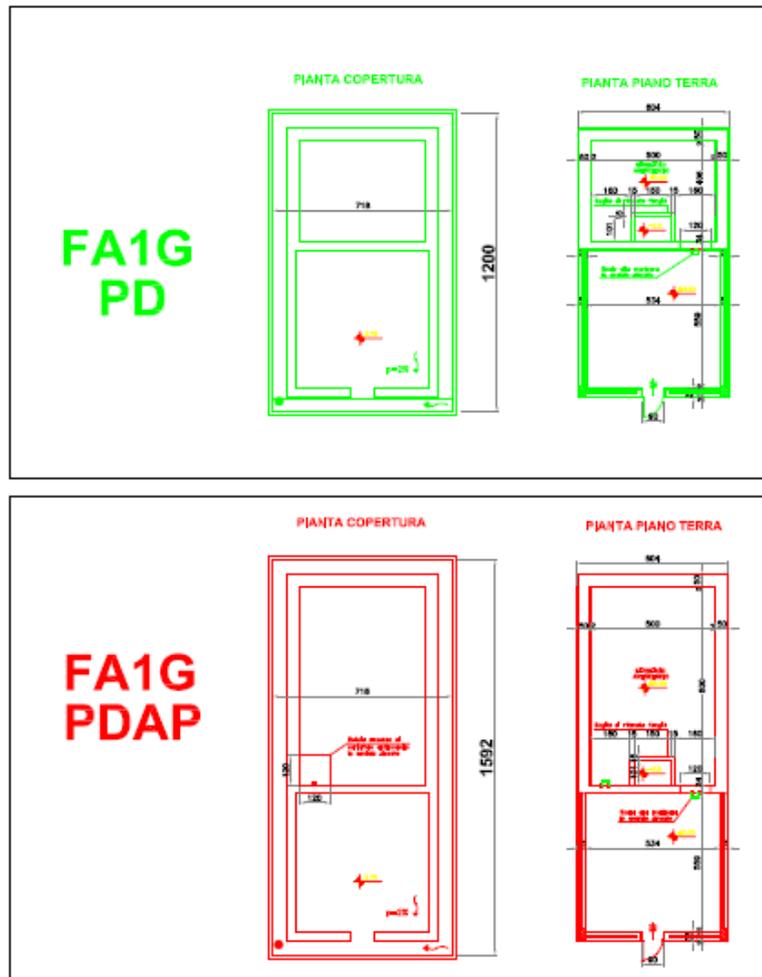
In alto in verde la planimetria della versione PD e in basso in rosso la versione PDAP
